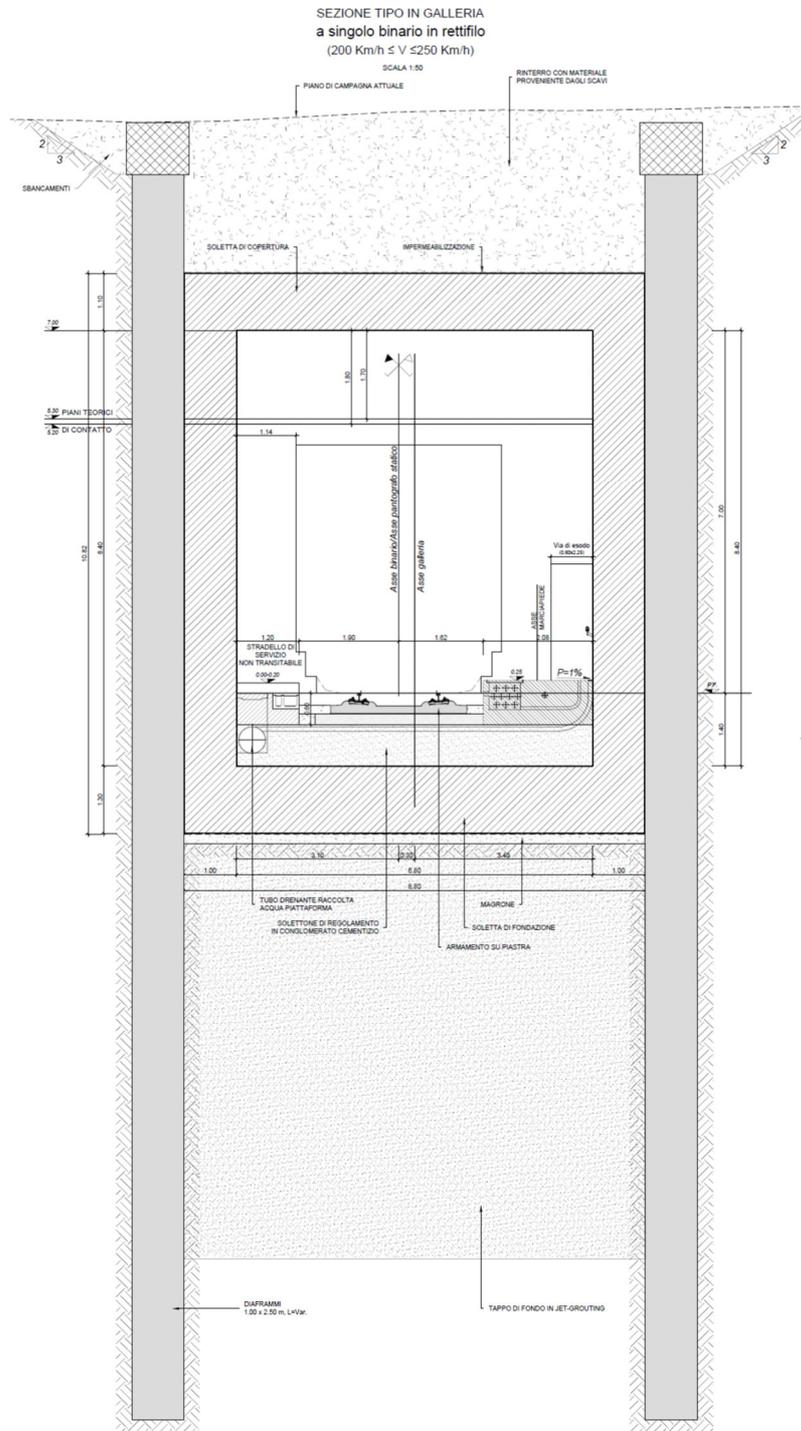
Sezione tipo GA singolo binario con armamento su piastra - rettilineo
